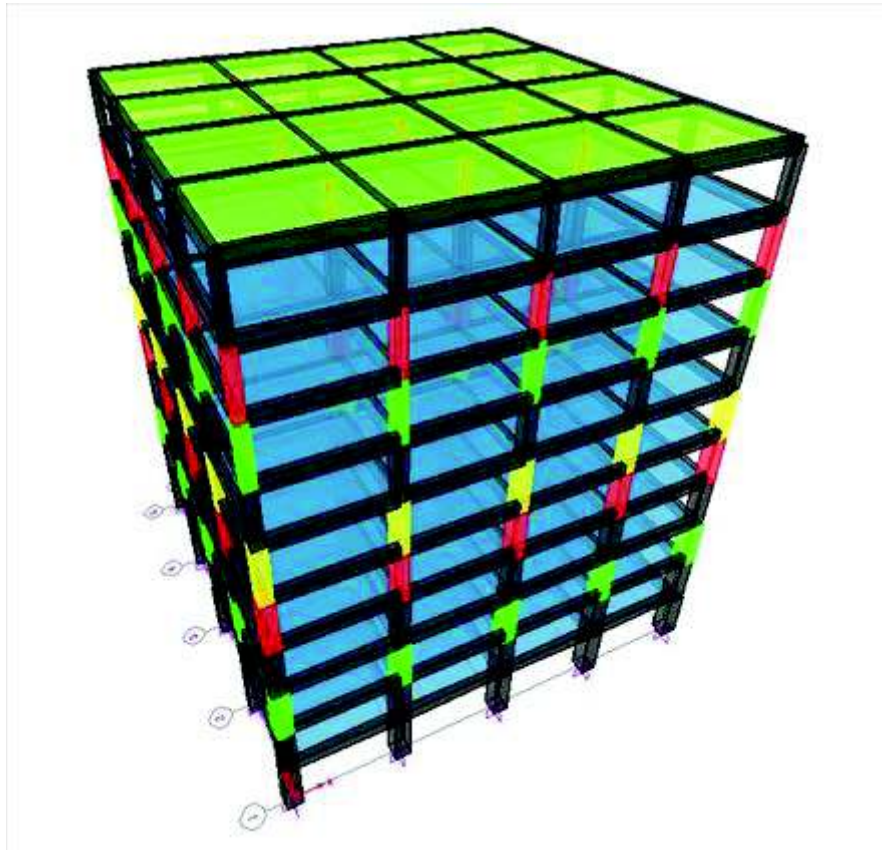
Edificio de 10 Pisos – Tridimensional
